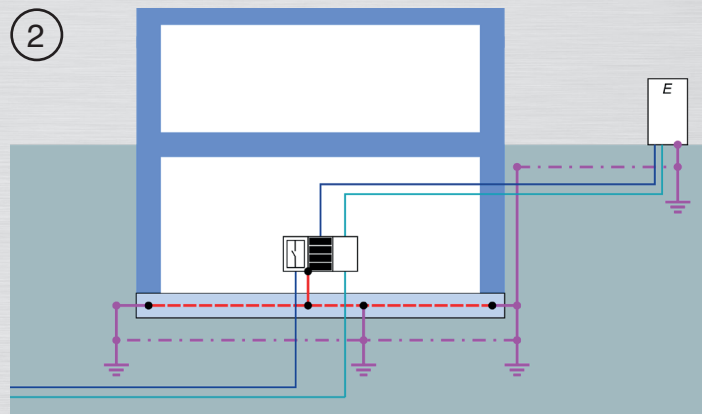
Ladeeinrichtung aus Gebäude versorgt
